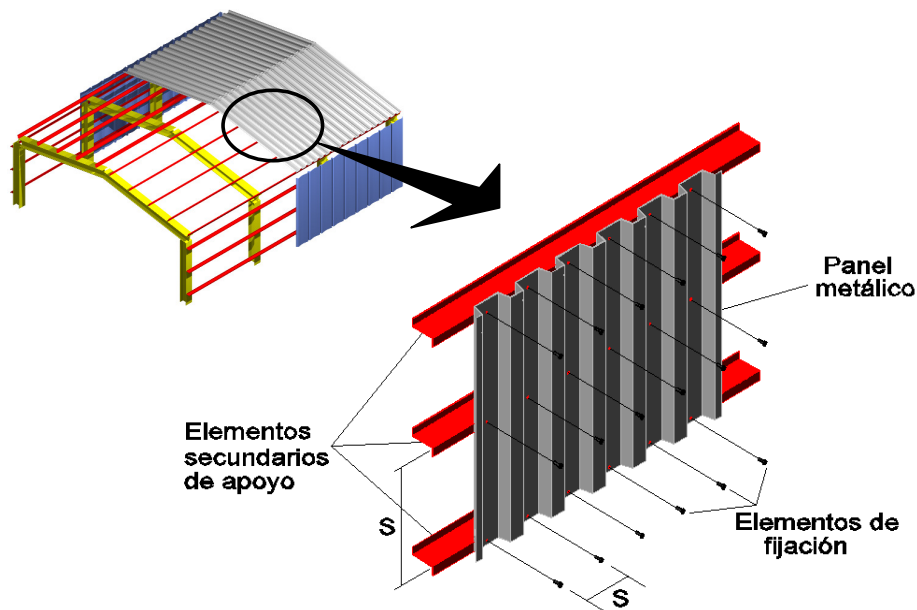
Componentes del sistema de fachada y cubierta en lámina metálica.
